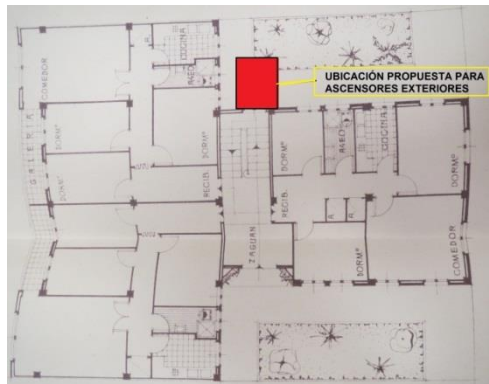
Proyecto de edificación bloques fase B. Plano de un bloque de viviendas con el detalle de la ubicación de ascensores propuesta.. Año 1962. Fuente: Archivo Municipal de Puçol –Autor.
